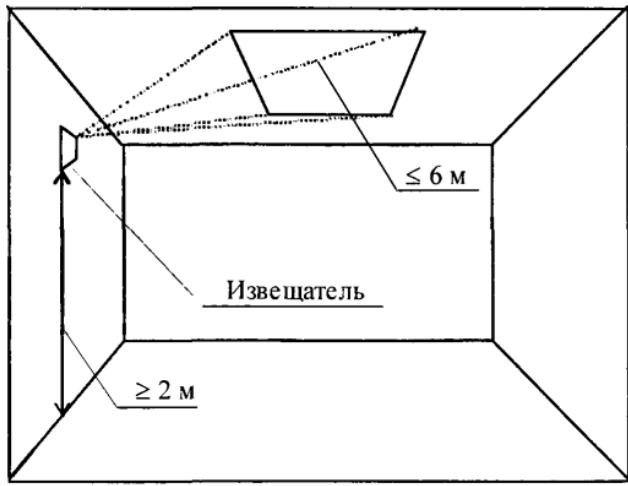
На боковой стене (охрана остекленного перекрытия)
